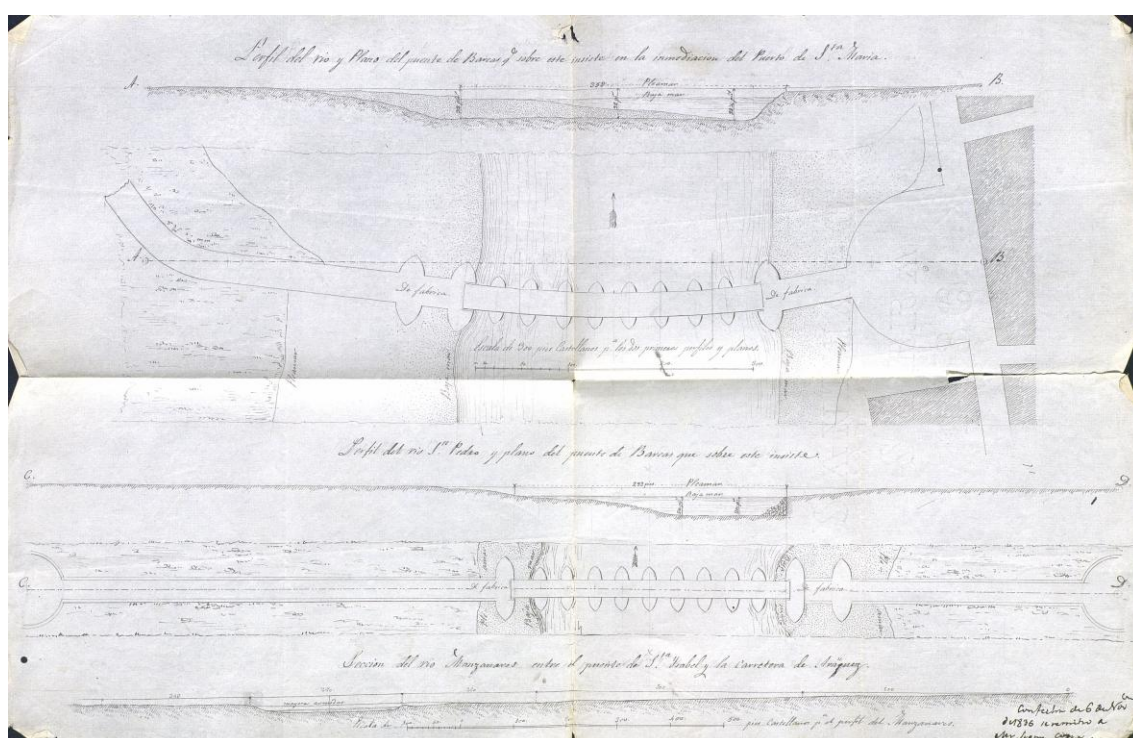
Perfiles y planos de los puentes de barcas de San Alejandro y San Pedro.
